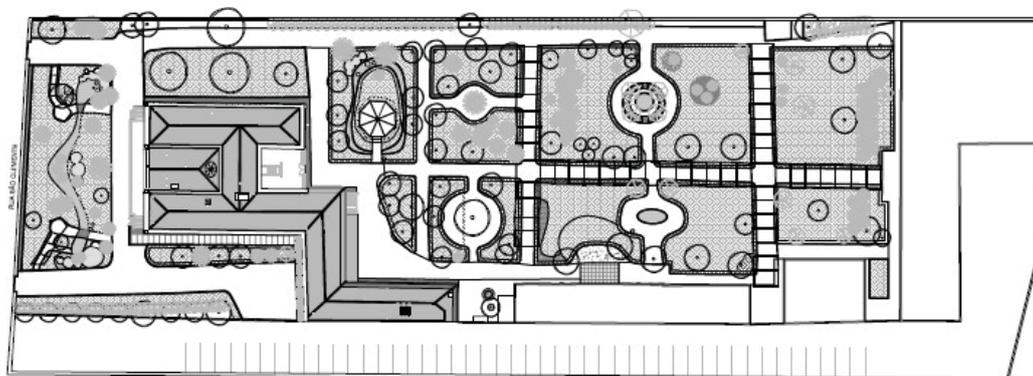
Planta do Jardim da Fundação Casa Rui Barbosa. (Fundação Casa Rui Barbosa, s.d.)
